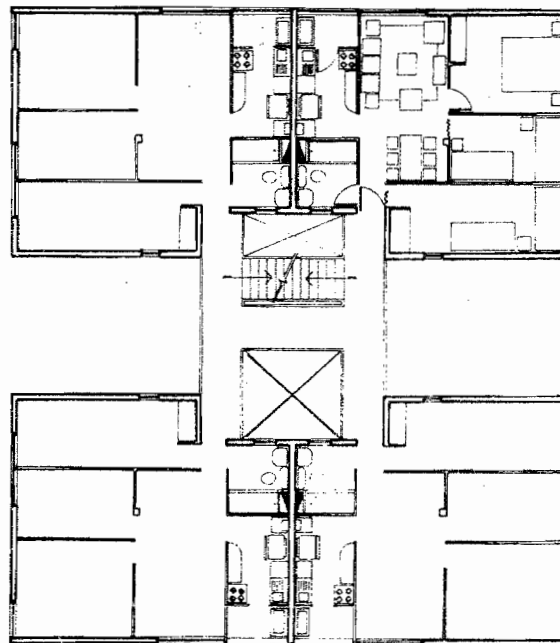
Prototipo de bloque en altura construido por Empresa Viviendas Económicas GAMA S.A.
